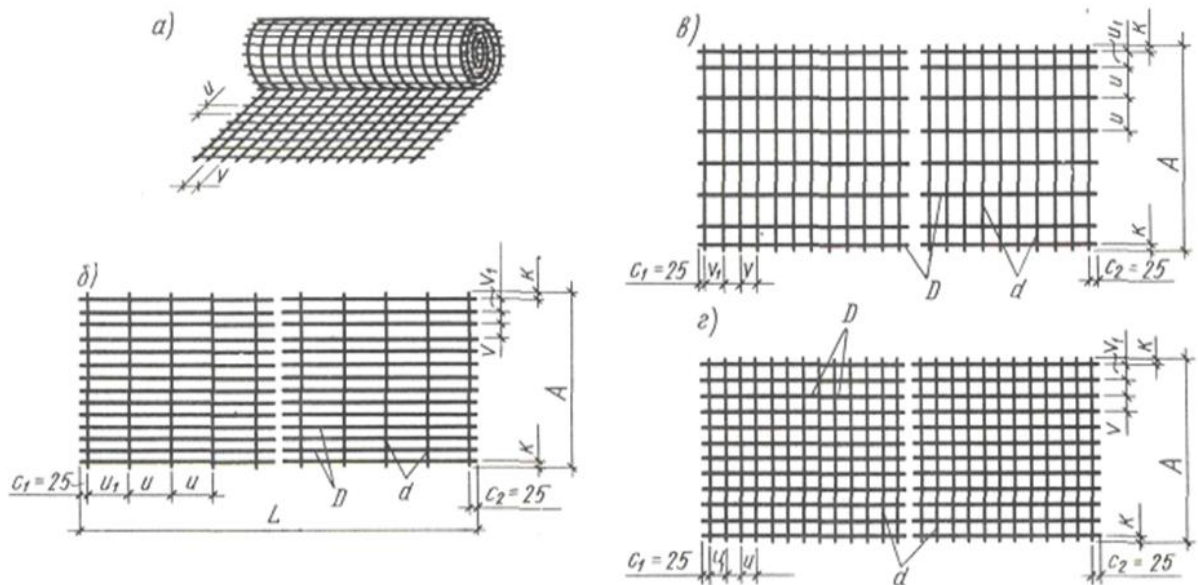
Зварні арматурні сітки: а – рулонні; б, в, г – плоскі з робочою арматурою, відповідно поздовжньою, поперечною і робочою в обох напрямках; D – діаметр робочих стрижнів; d – діаметр розподільчих стрижнів; A – ширина сітки; v та u – відстань між осями робочих і розподільчих стрижнів
